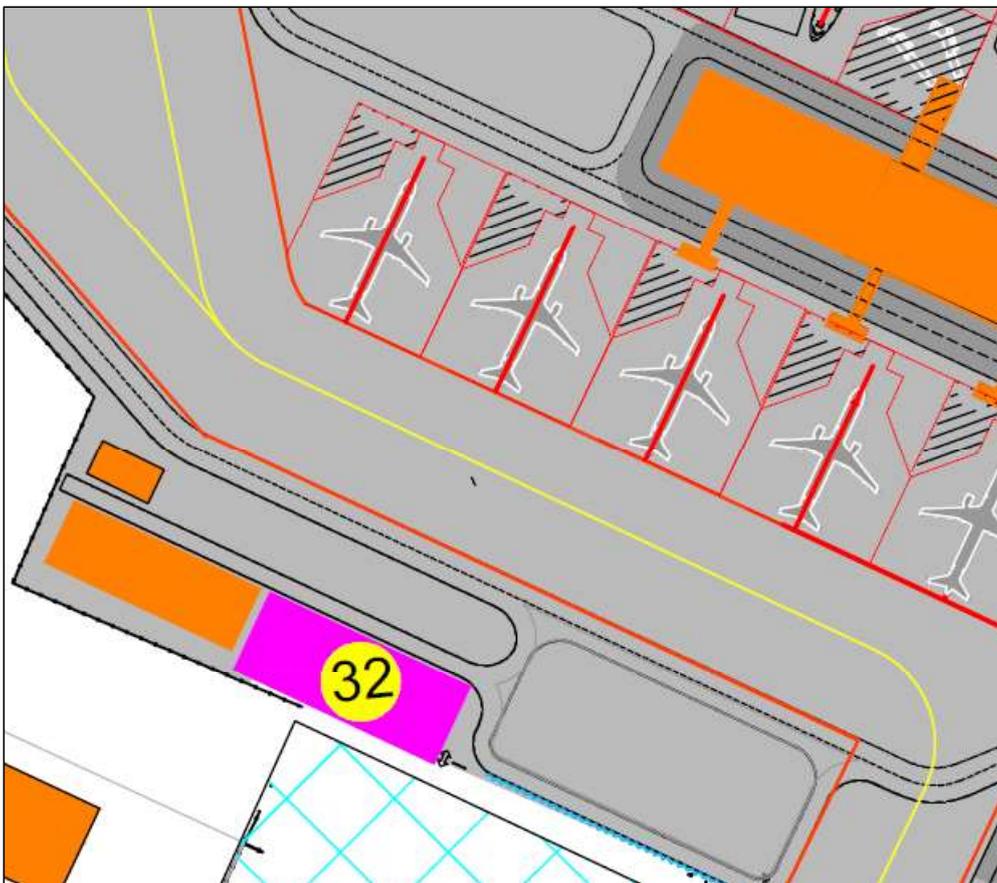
Estratto Master Plan – Edificio Mezzi di Rampa e Officina
